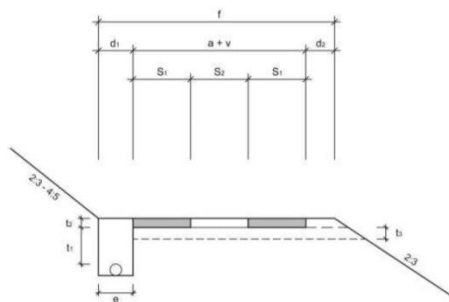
Flexibler Oberbau – Einschnitt und Auffüllung (mit Entwässerung).
